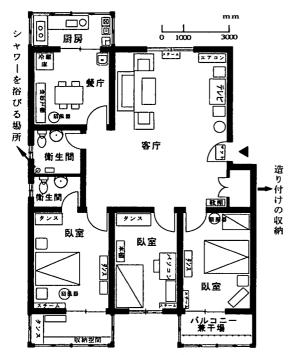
調査対象住宅の平面図 (タイプ 1 約 123 m²)
